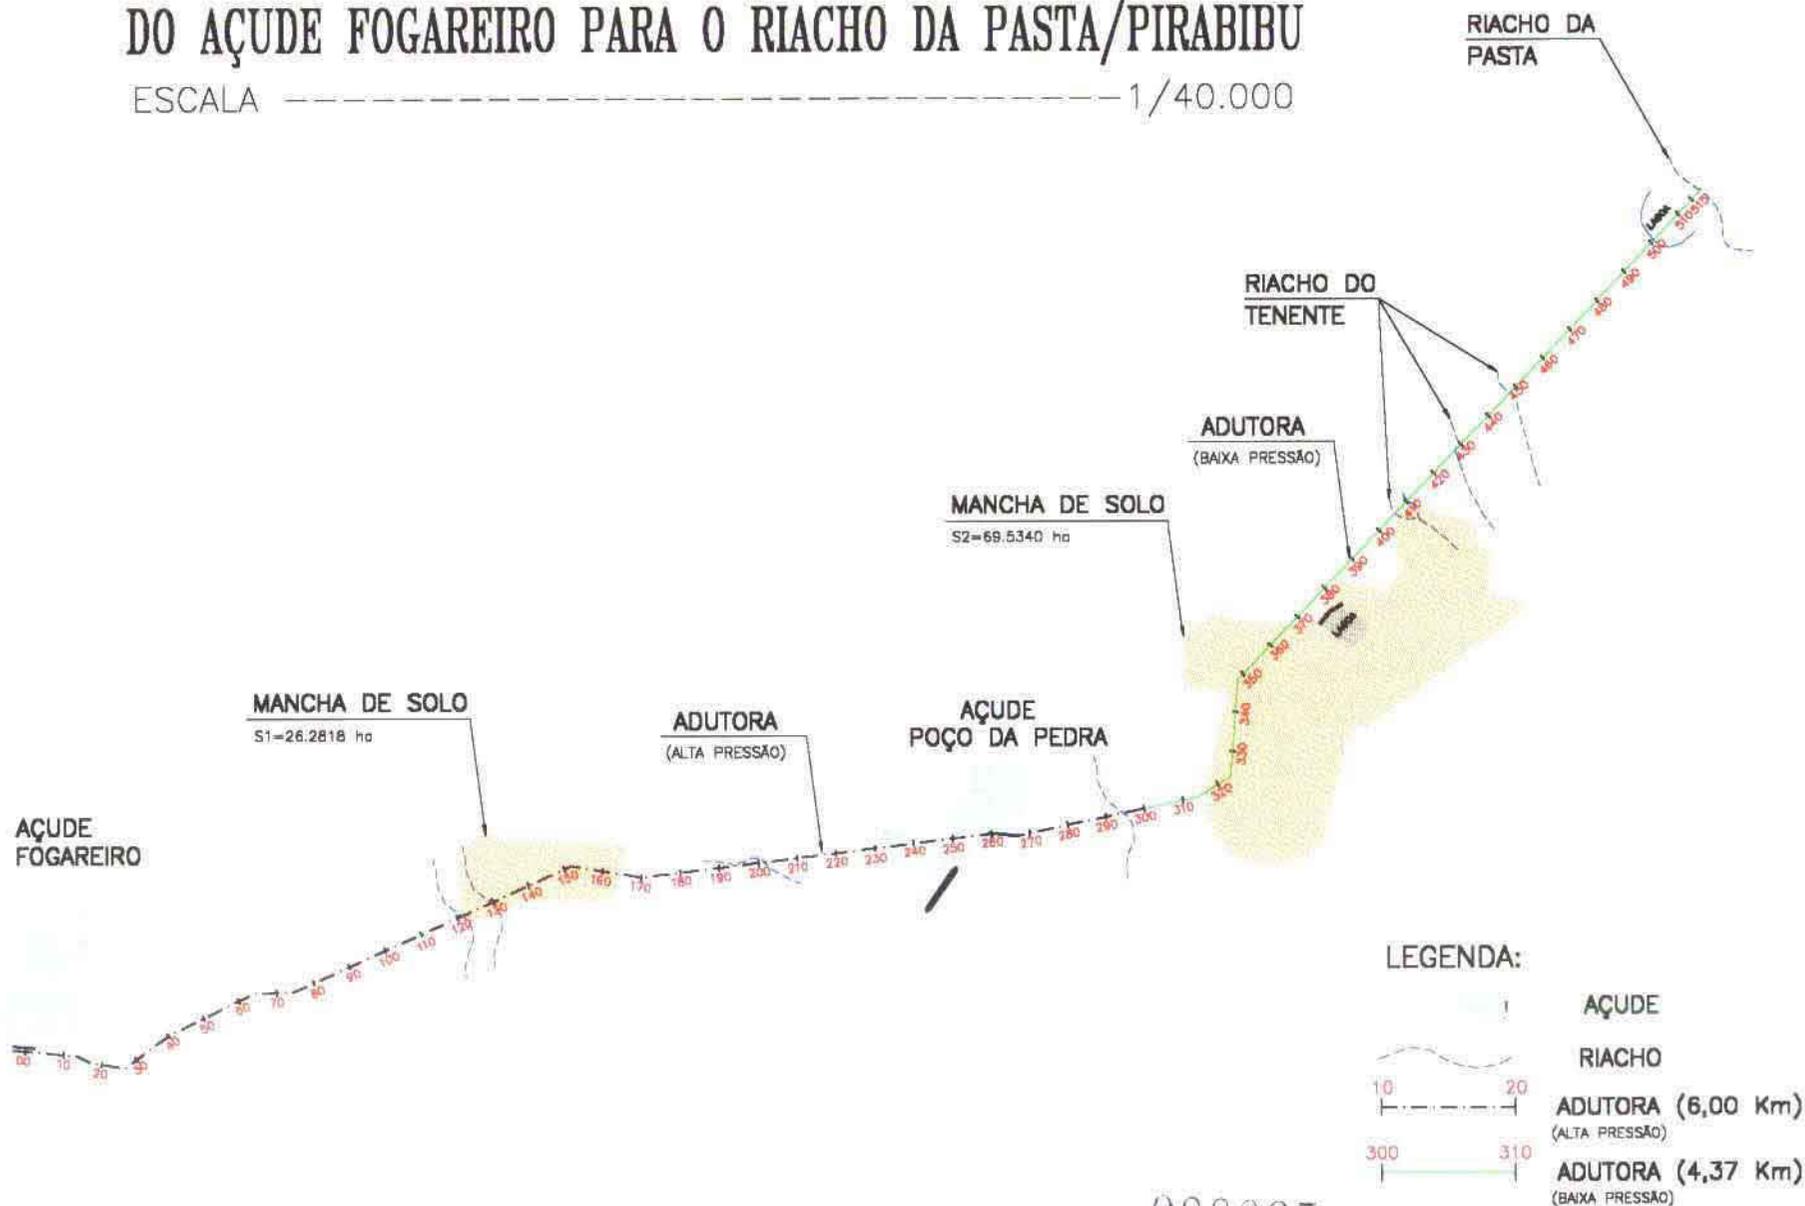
ALTERNATIVAS DE TRAÇADO
